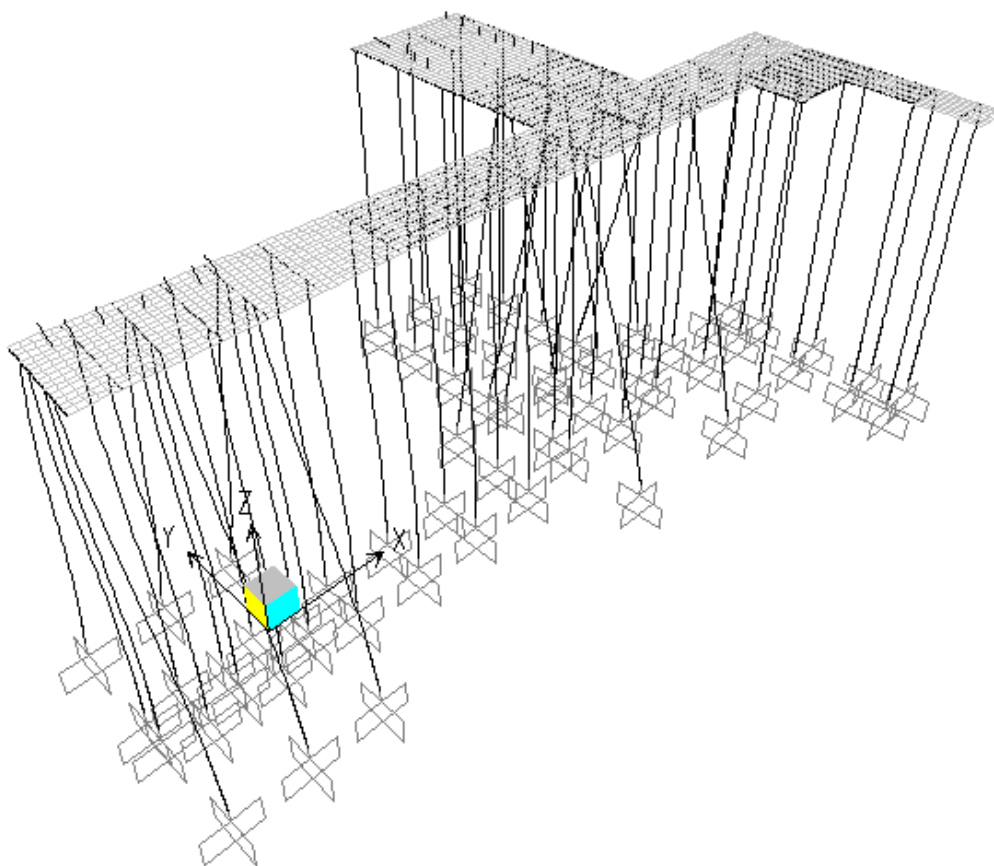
Configuração Deformada – 3D – Amarração – Projeto Alternativo
